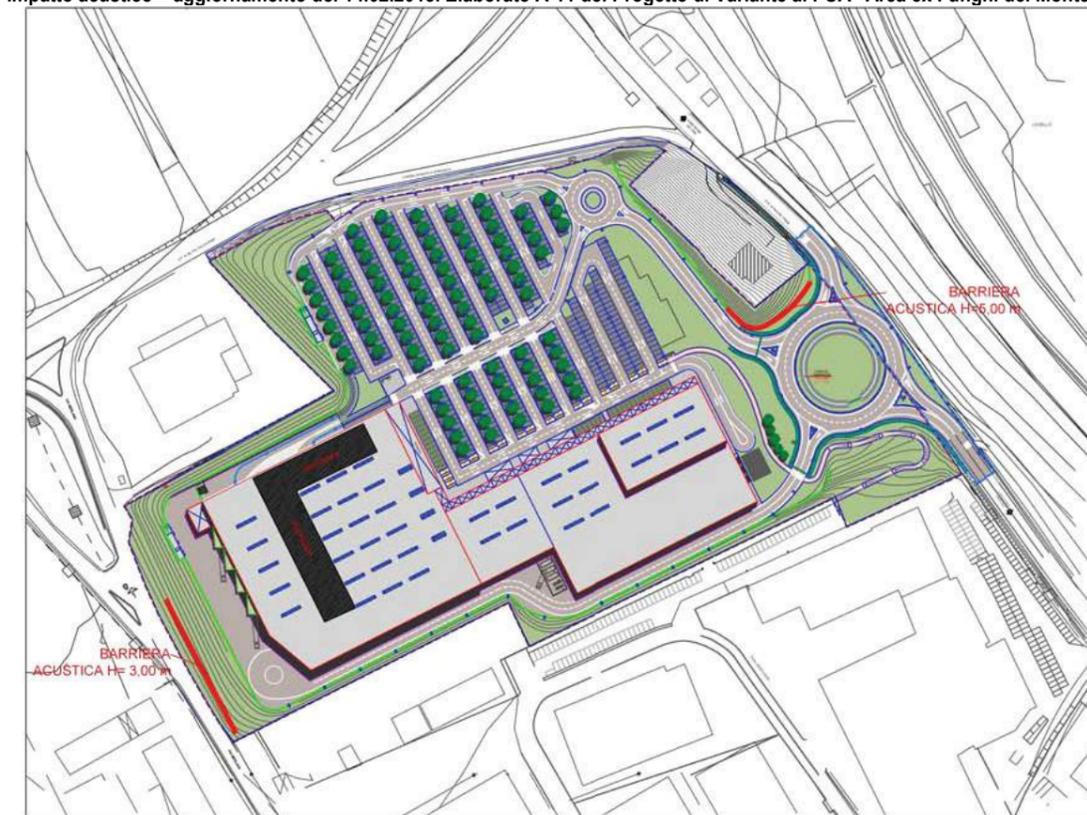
schema planimetrico riportante l'ubicazione dei presidi di protezione acustica proposti col progetto di variante (e dalle attività di carico/scarico dei mezzi di approvvigionamento Fonte: Documentazione previsionale di impatto acustico – aggiornamento del 14.02.2018. Elaborato A-11 del Progetto di Variante al PUA "Area ex Funghi del Montello).
